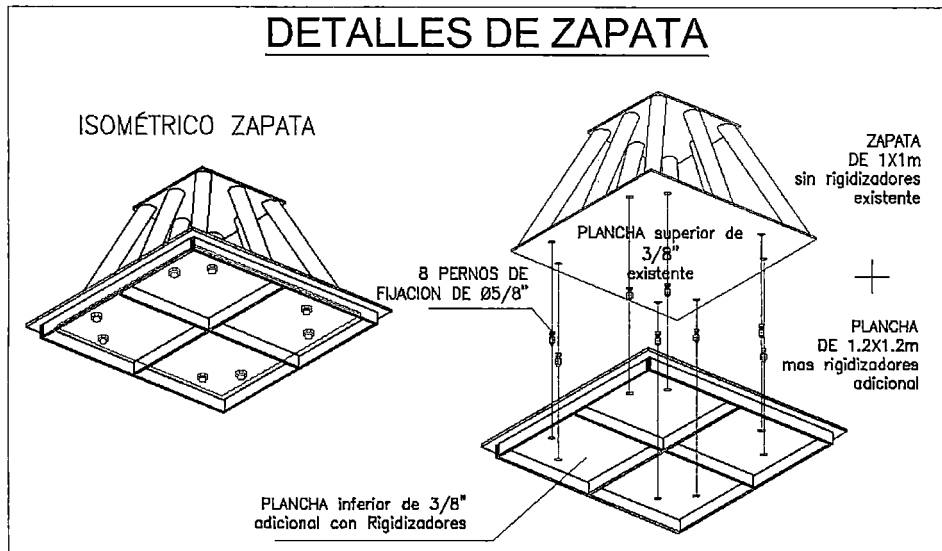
Diseño de las zapatas que son el soporte de la plataforma metálica.
